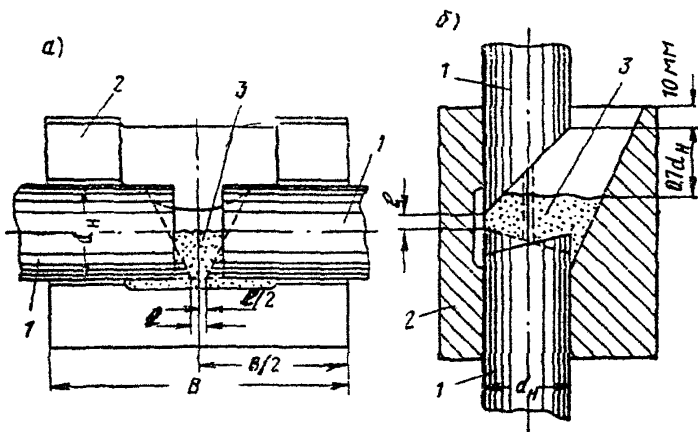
Установочные размеры при сборке инвентарных форм для сварки стыковых соединений арматуры
